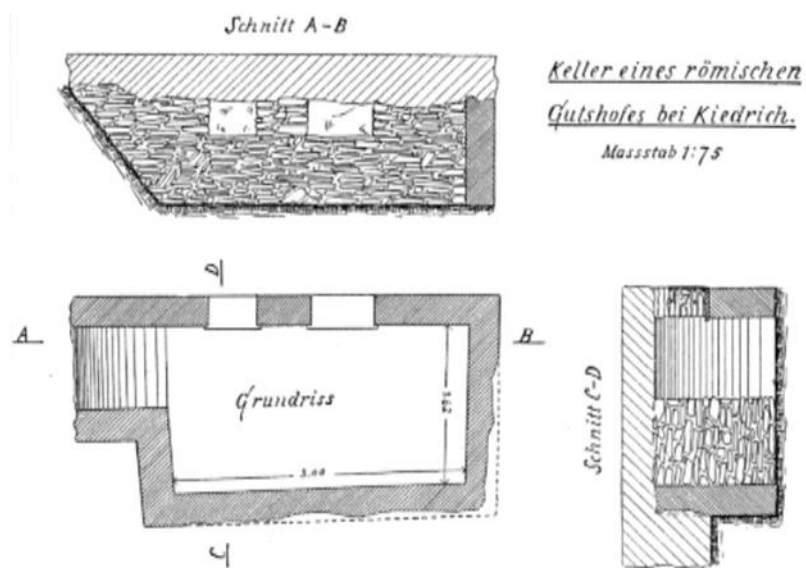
Grundriss des römischen Kellers auf dem Gelände der Gärtnerei Bellinghausen in Kiedrich.
